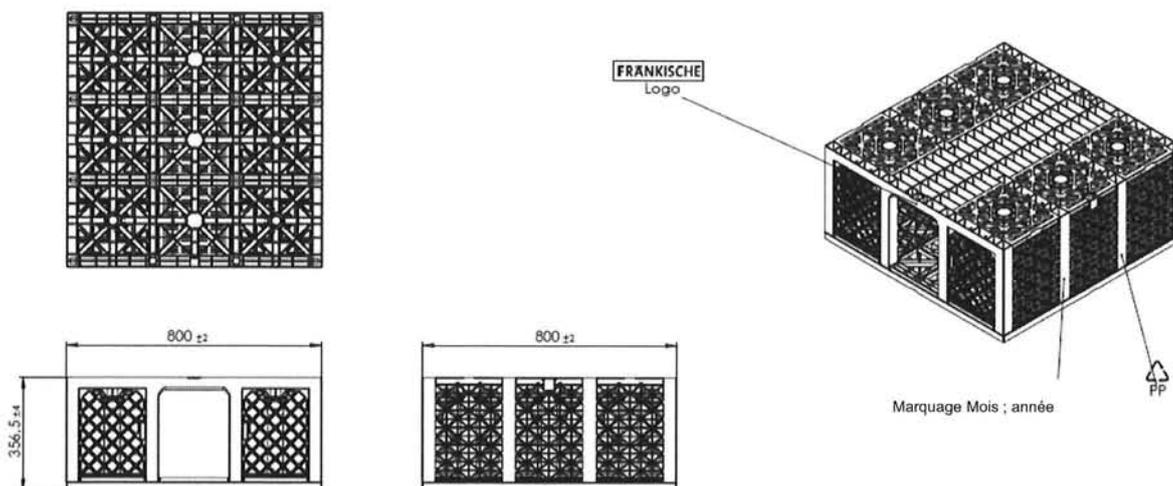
c- Caractéristiques dimensionnelles du demi-module RIGOFILL INSPECT
